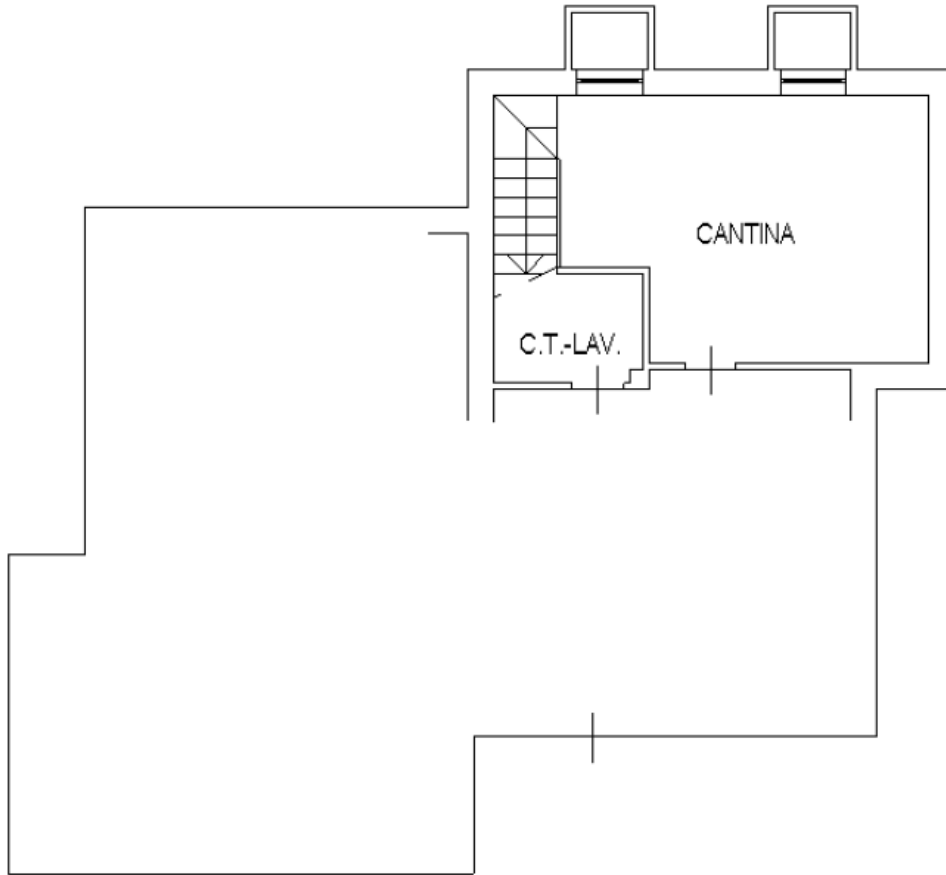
Estratto della planimetria catastale – sub. 2, p.int.
